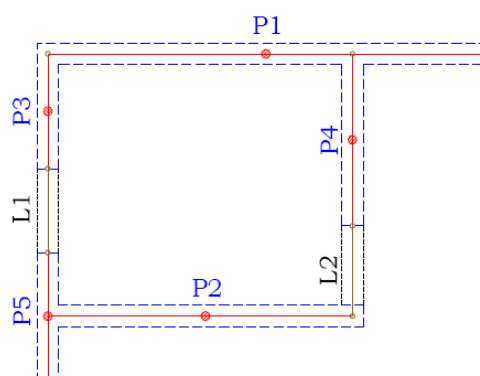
Planta baixa da modelagem tridimensional com elementos de barra (NASCIMENTO NETO, 1999).
